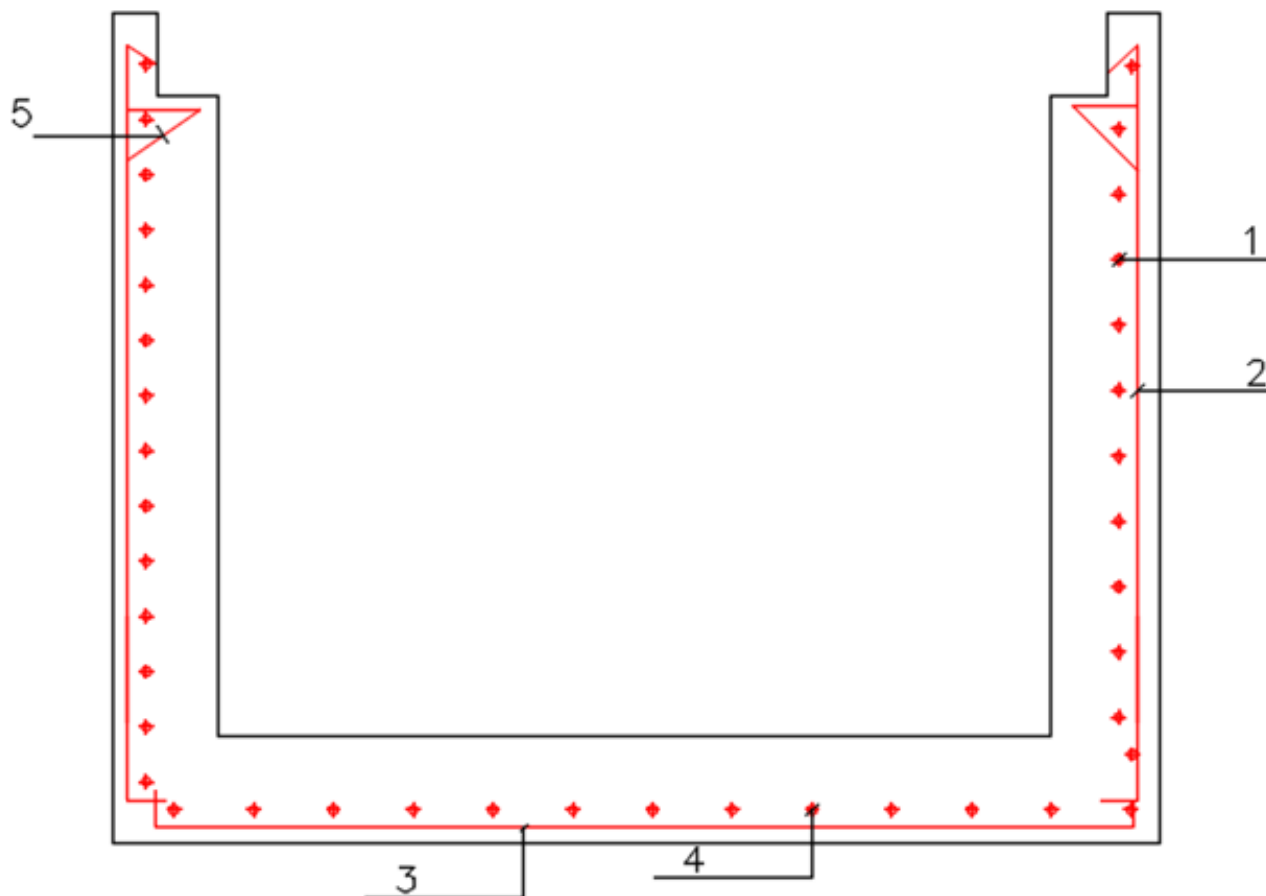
Extrait du plan de ferrailage du caniveau 100x120 cm²
